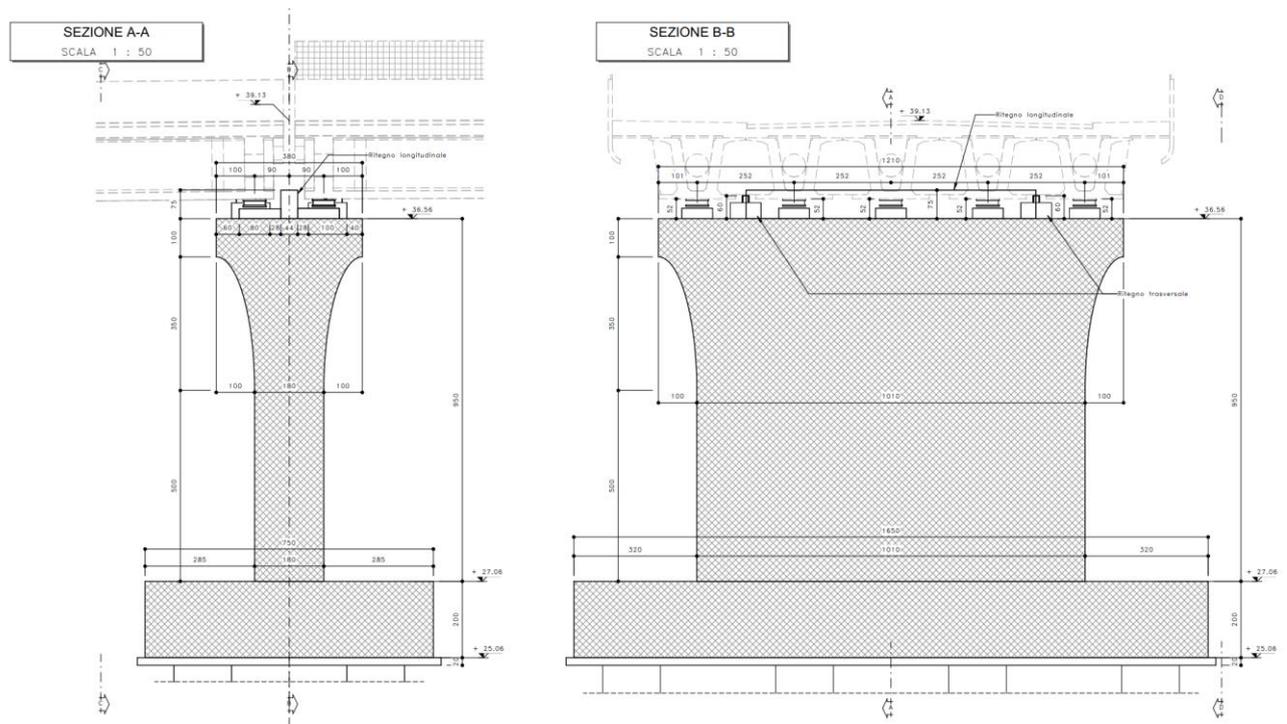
Sezione longitudinale e trasversale pila solo impalcata c.a.p.
